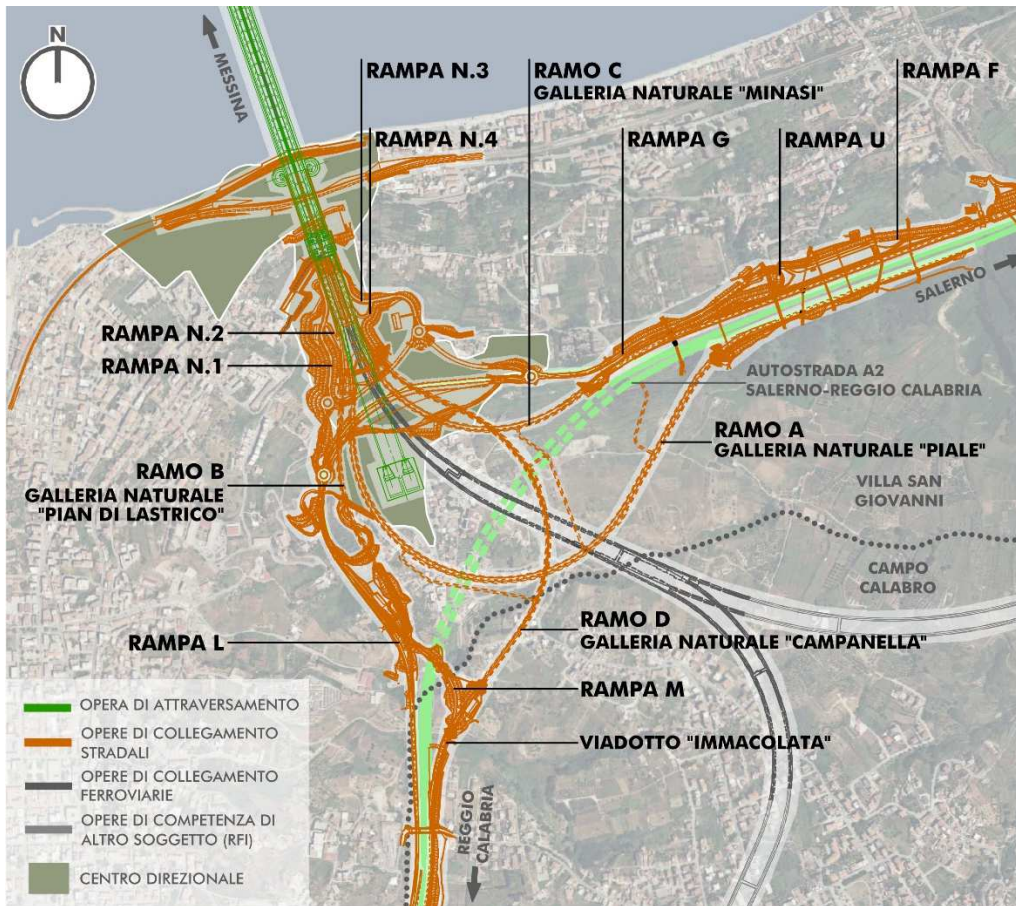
Stralcio planimetrico con indicazione dei rami, delle rampe e delle principali opere d'arte di progetto costituenti i collegamenti stradali sul versante Calabria
